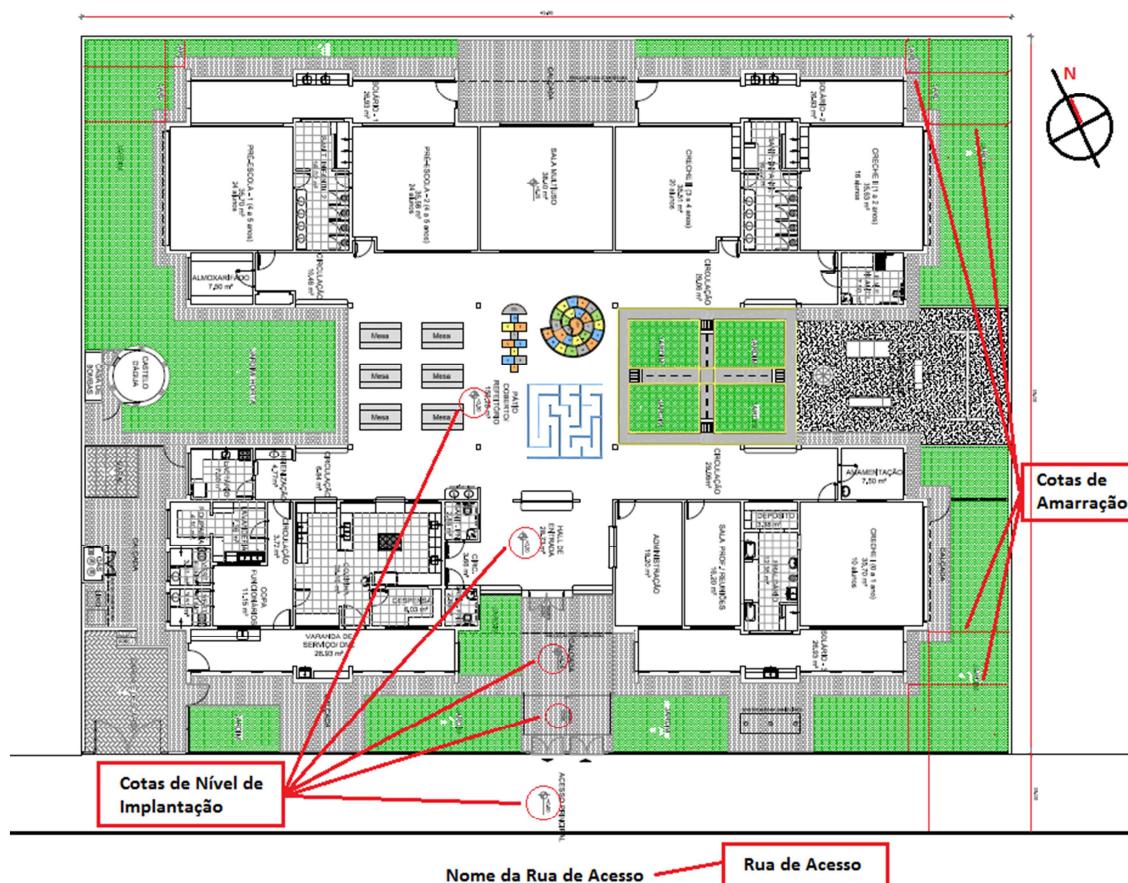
Exemplo de “Planta de Locação” da obra da Creche Tipo 2.
